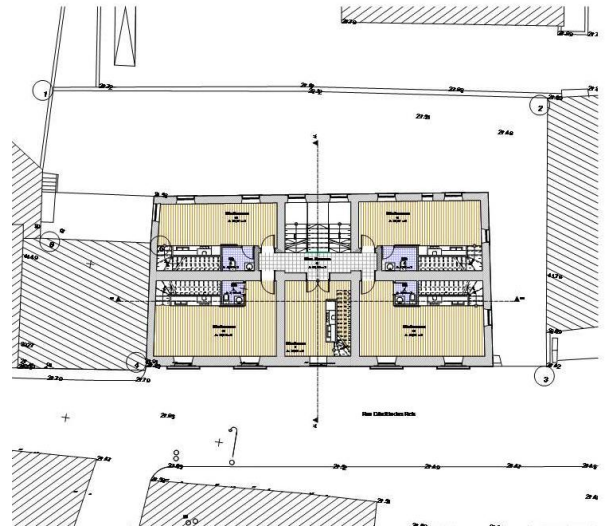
Planta 1º Piso, Proposta, Autor, 2017
